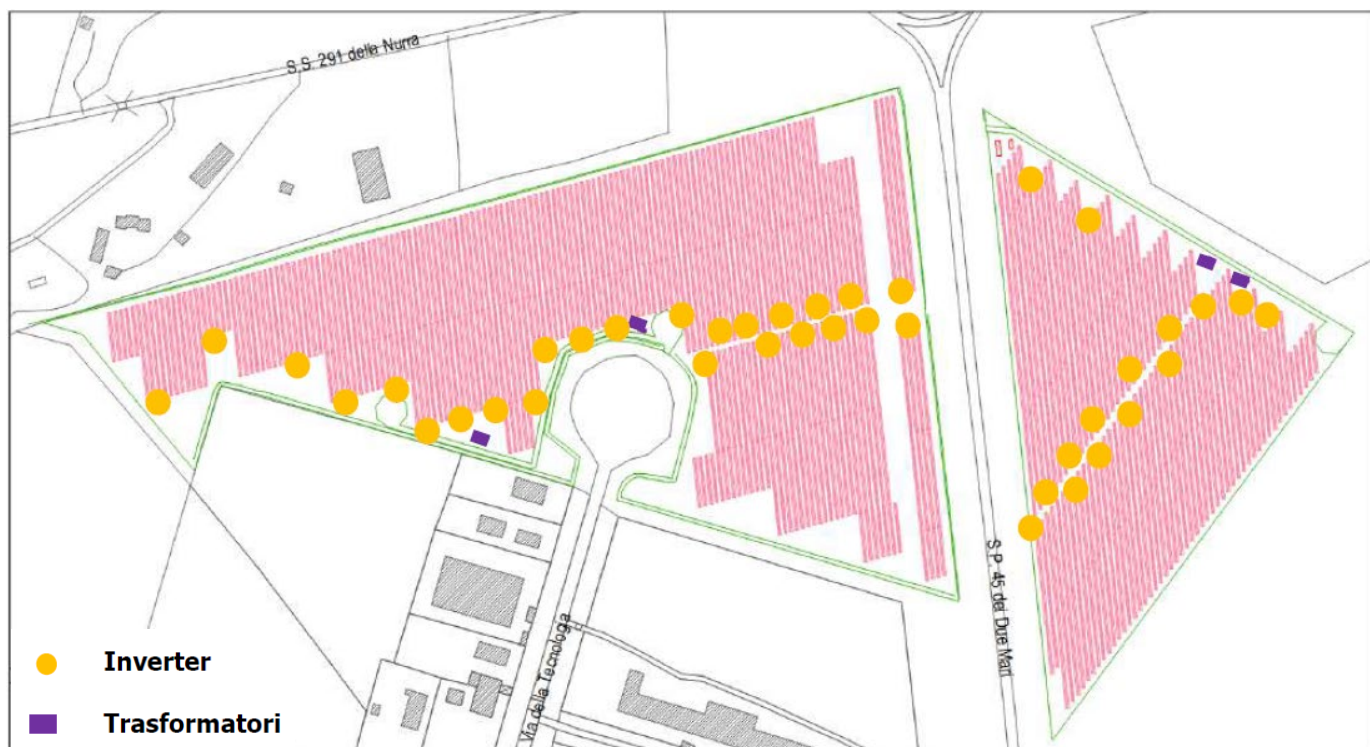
Planimetria con localizzazione delle sorgenti di progetto
